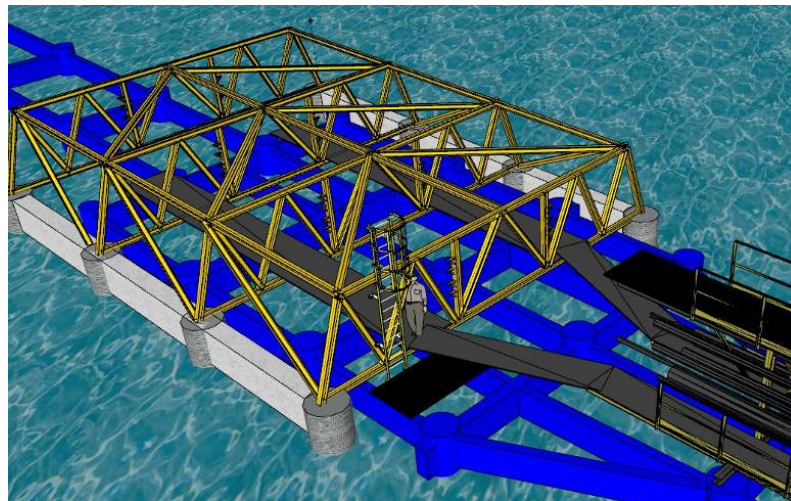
Render sistema strutturale nella piazzola intermedia del pontile
